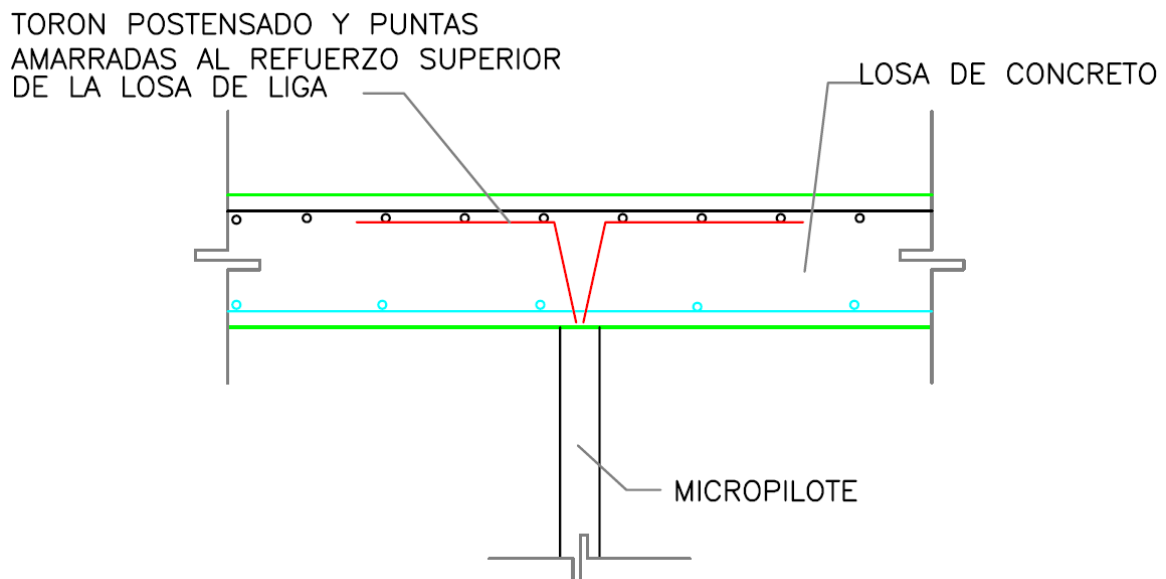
Corte transversal del armado y amarre de torones provenientes del micropilote, con losa de cimentación.
